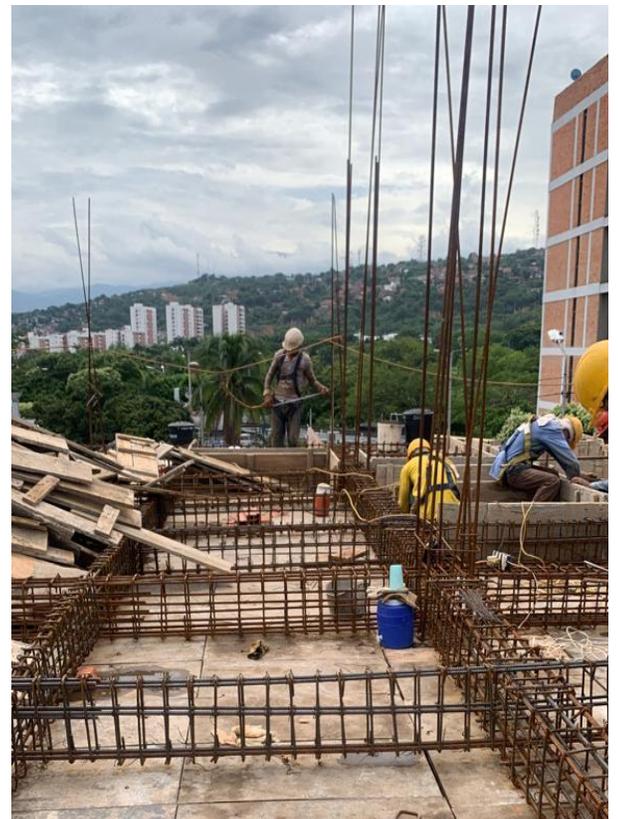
Armado y encofrado de vigas nivel 4 ejes 1-2. Edificio Wiedii.
